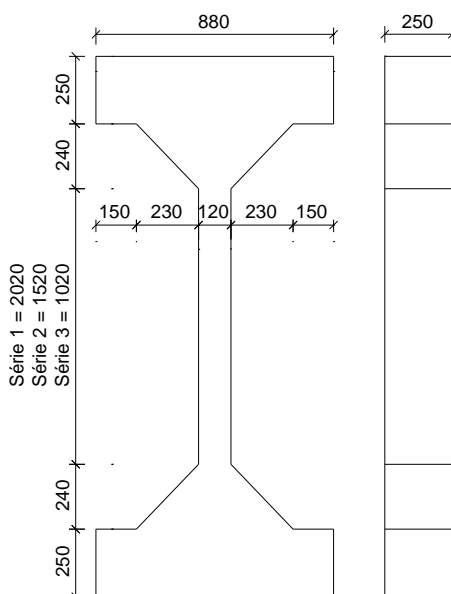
Dimensões dos pilares ensaiados (MELO 2009)
